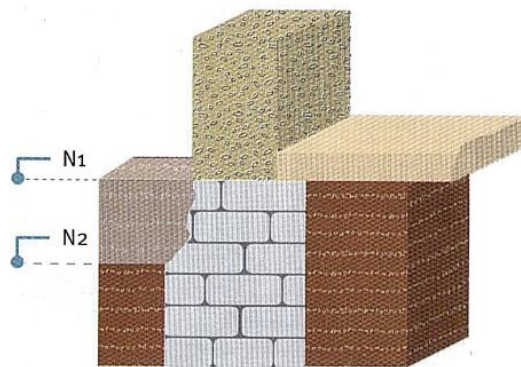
METEORIZAÇÃO DE FUNDAÇÕES EXPOSTAS NA SEQUÊNCIA DE ESCAVAÇÕES [3].
